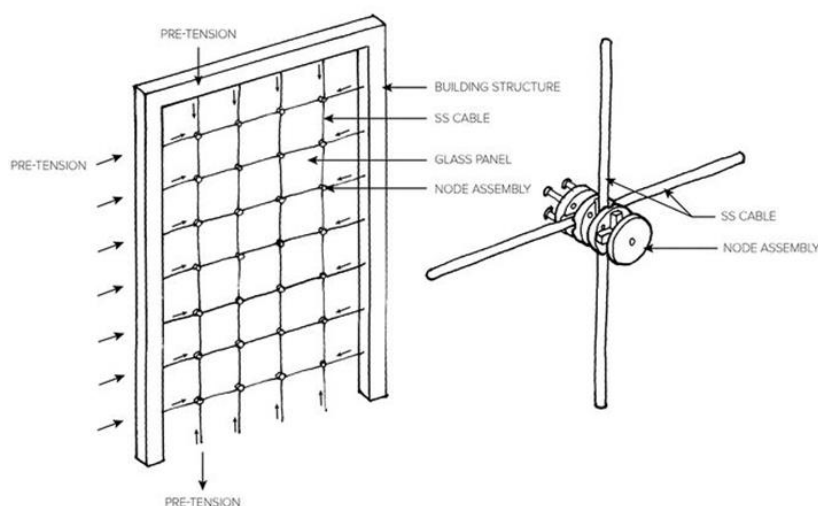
Sistema strutturale di una facciata a cavi tesi con dettaglio collegamento del nodo cavi [4]
